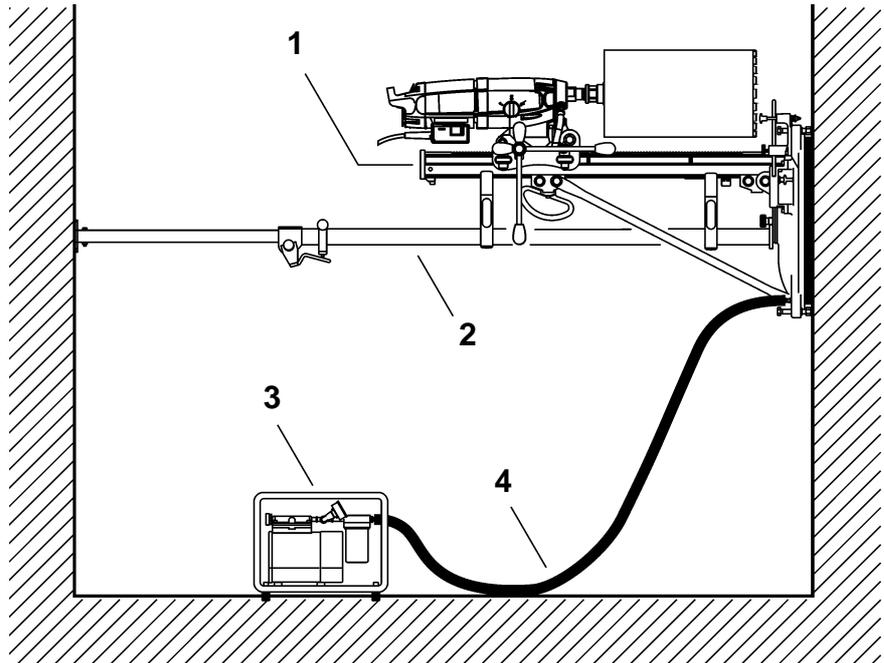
Gesichertes Vakuum-Kernbohrsystem
